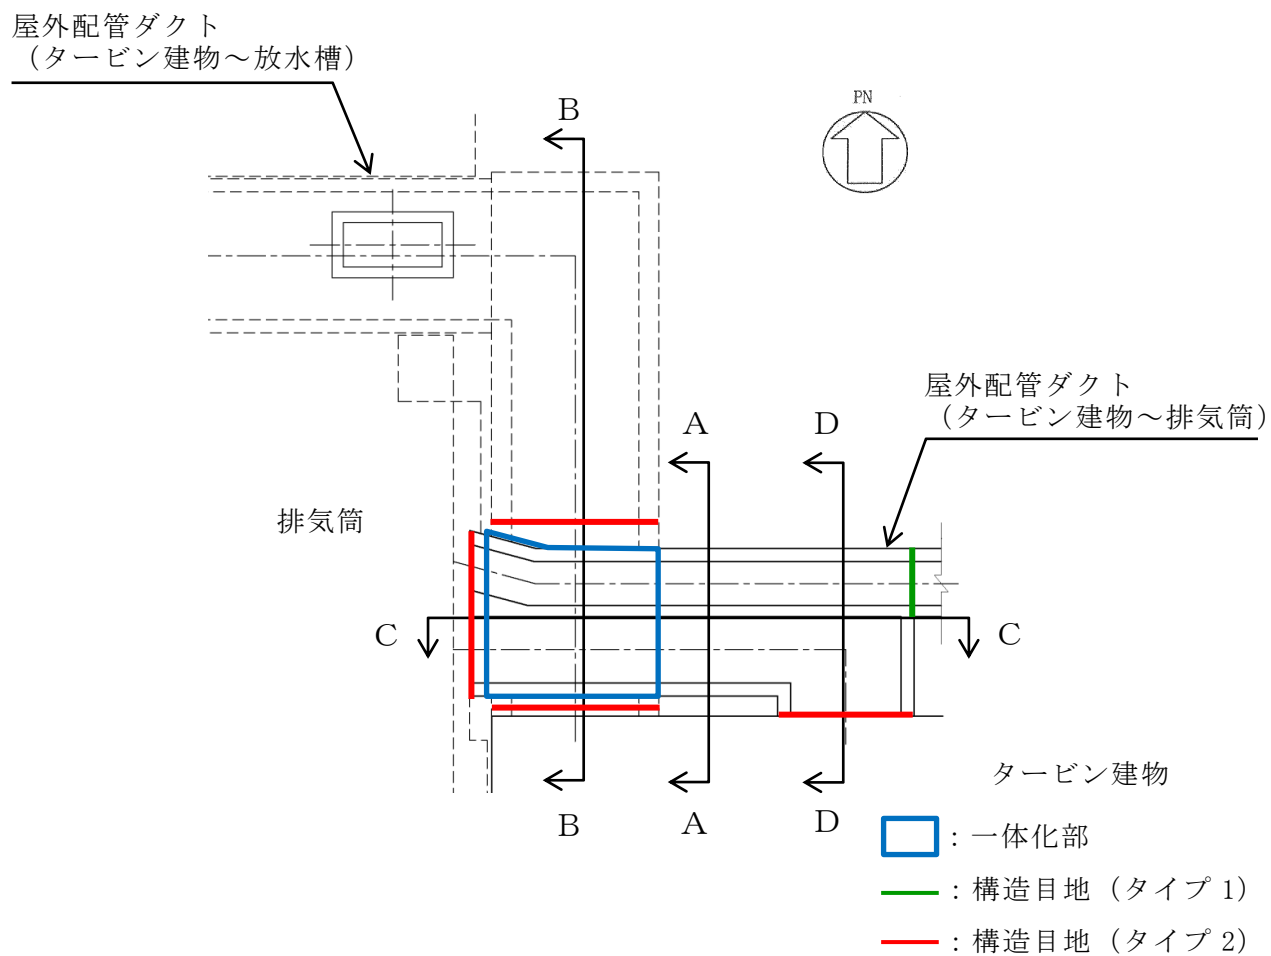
屋外配管ダクト (タービン建物～排気筒) 平面図
